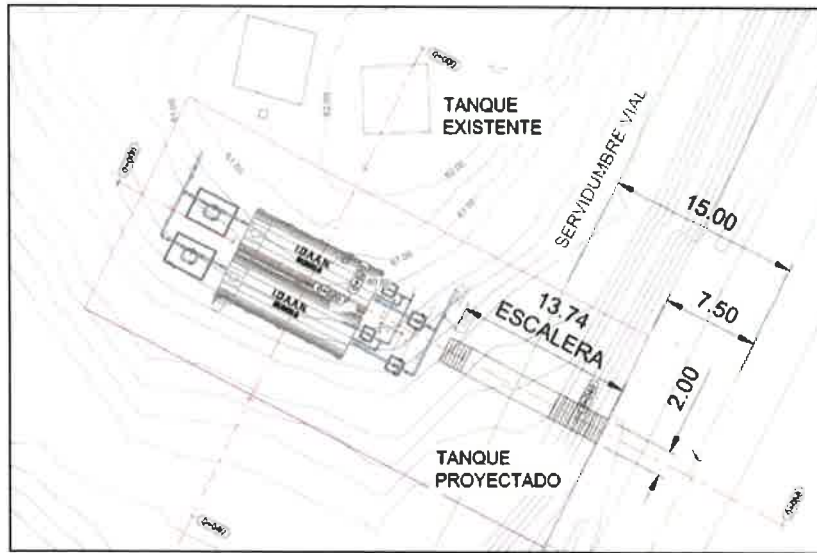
Vista en planta de escalera de acceso proyectada
